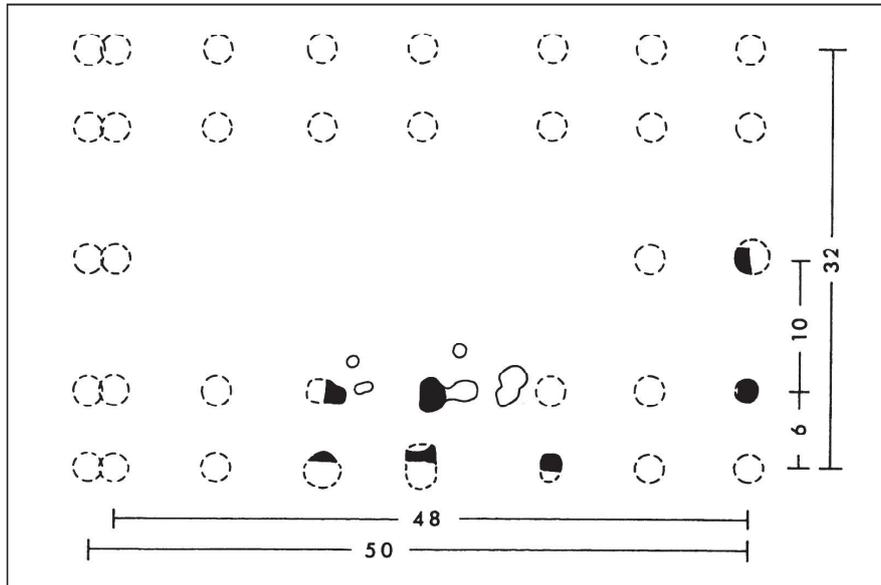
Aschheim St. Peter und Paul. Rekonstruierter Grundriss der frühmittelalterlichen Holzkirche mit Bemaßung in Fuß (nach Dannheimer 1988 [Anm. 35] 69 Abb. 12 a).
